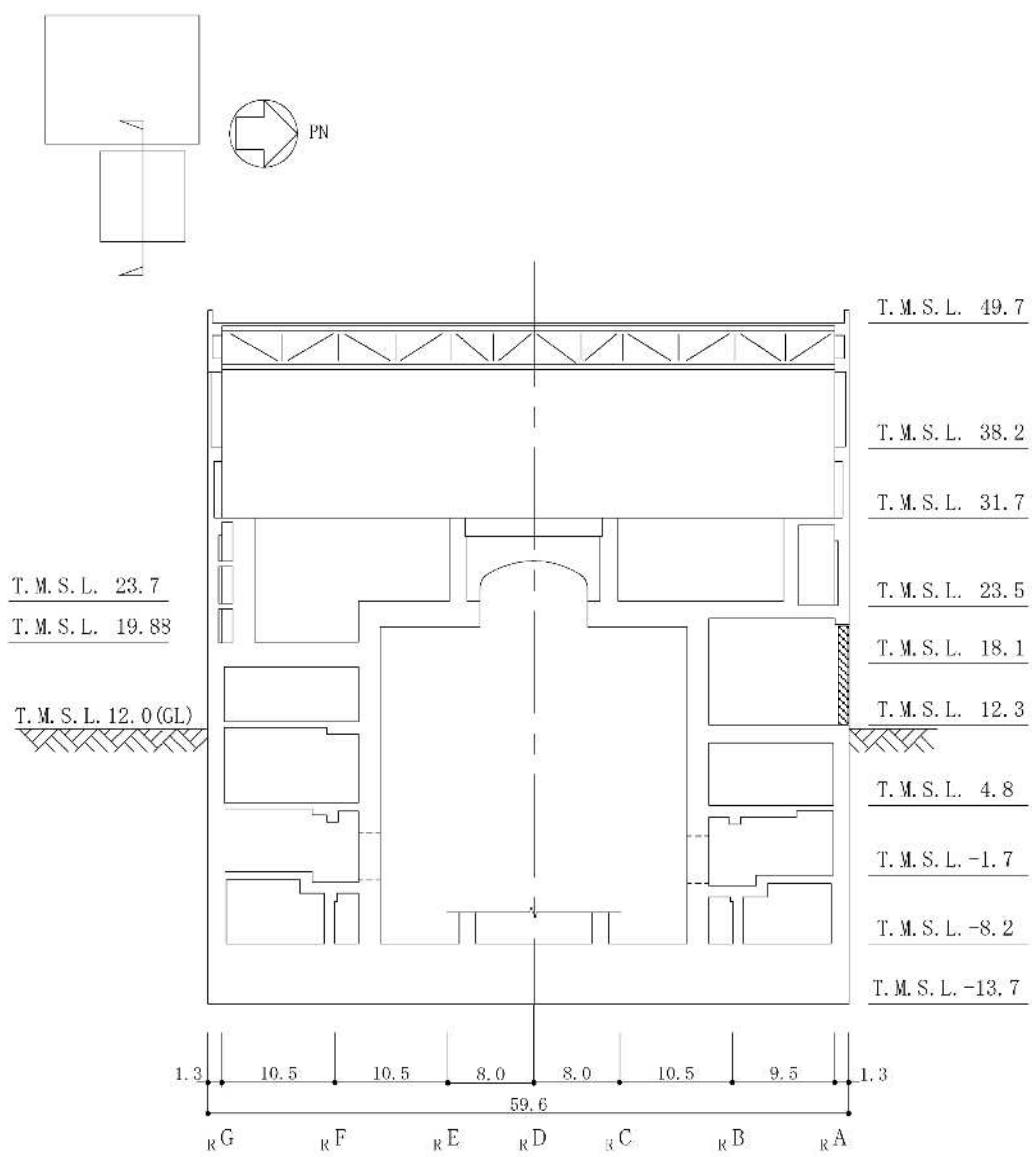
MS トンネル室 BOP の設置位置平面図 (単位 : m) (2/2)
